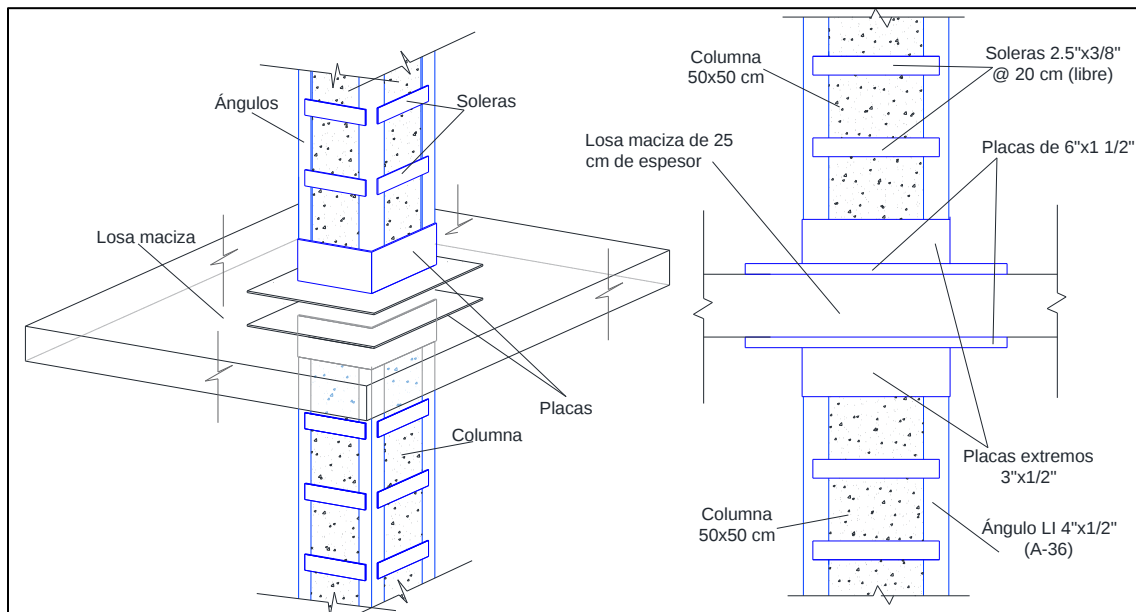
Unión del sistema de refuerzo con las placas y la losa.
